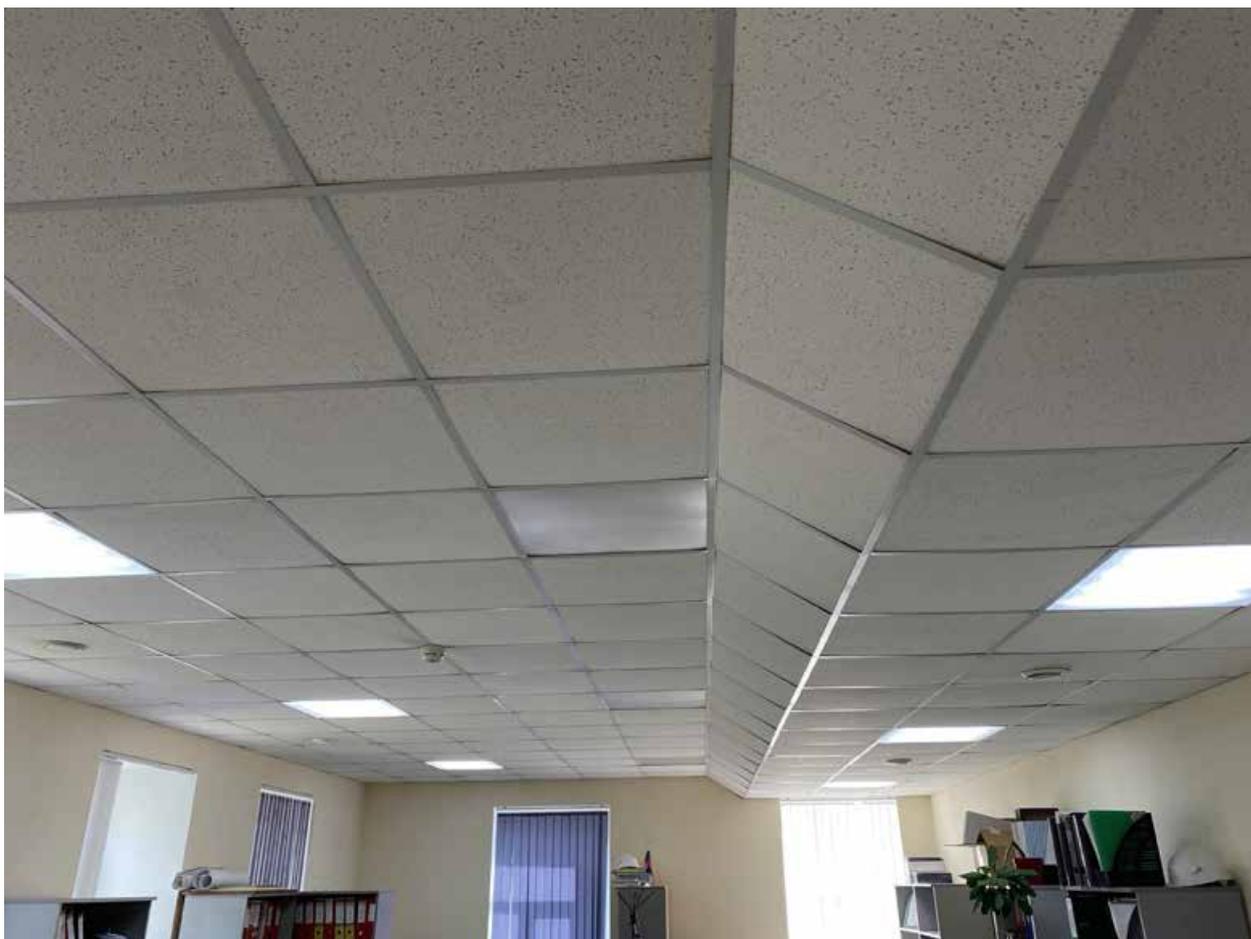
3 этаж. Помещение 7-Н(1-3).
